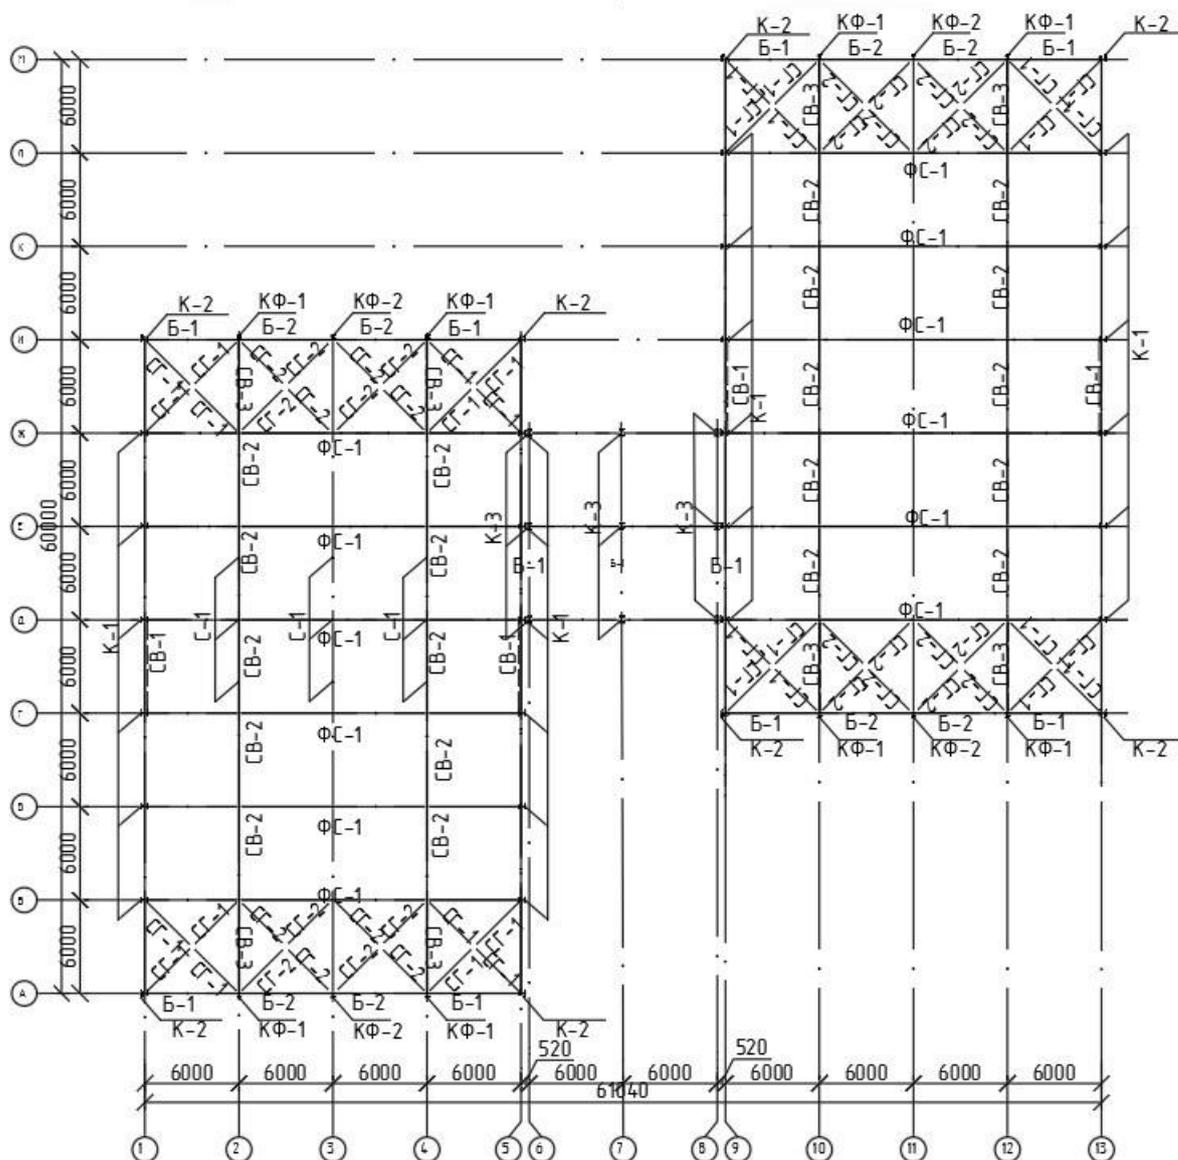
Схема расположения колонн, ферм стропильных, балок и связей.
